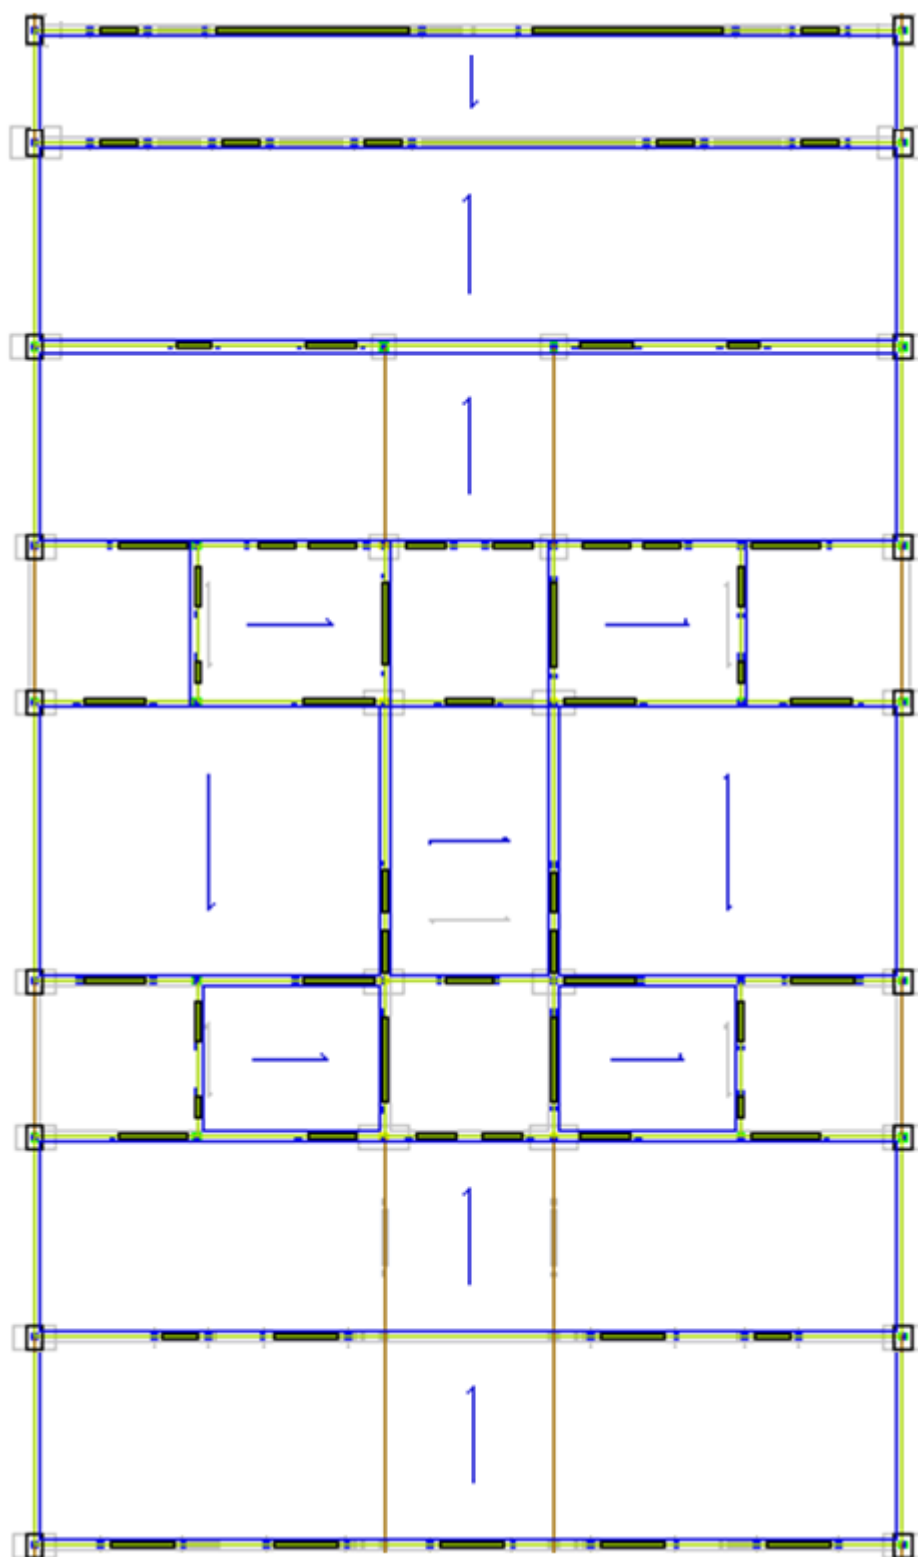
Croquis de planta tipa con todos sus elementos estructurales [fuente propia]
